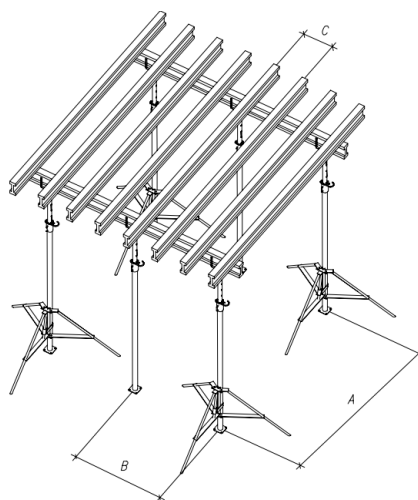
Схема расстановки телескопических стоек и раскладки балок опалубки перекрытий
